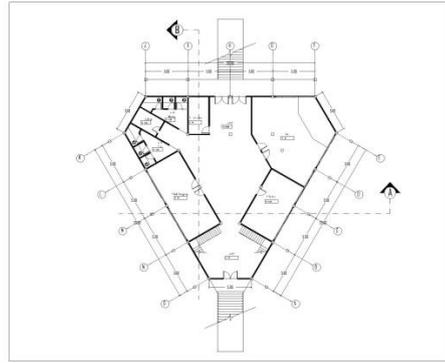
Denah Lantai 2 Ged. A (Mesjid)
